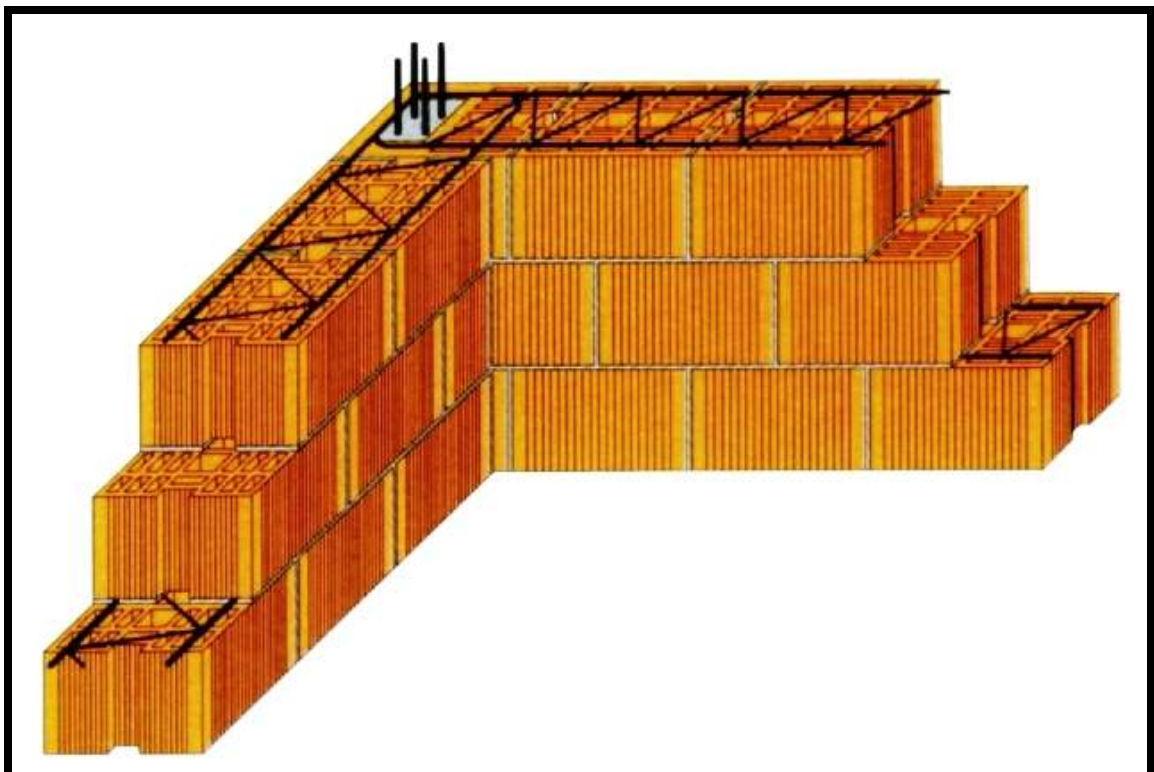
Parede estrutural armada com tijolos de furação vertical [3].
